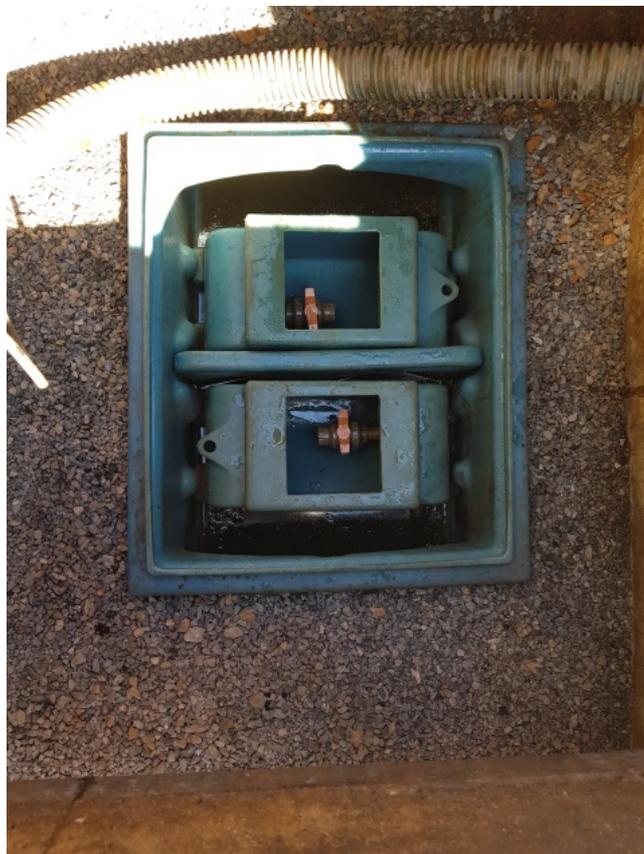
Caixa separadora de água e óleo da pista de abastecimento
